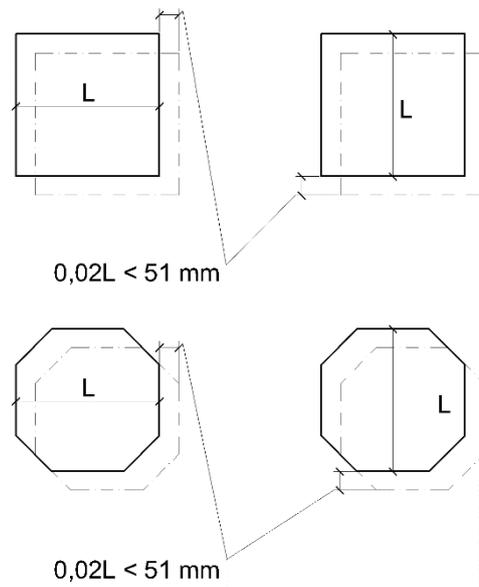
Vista en planta de desviación horizontal permisible en la ubicación de fundaciones.
